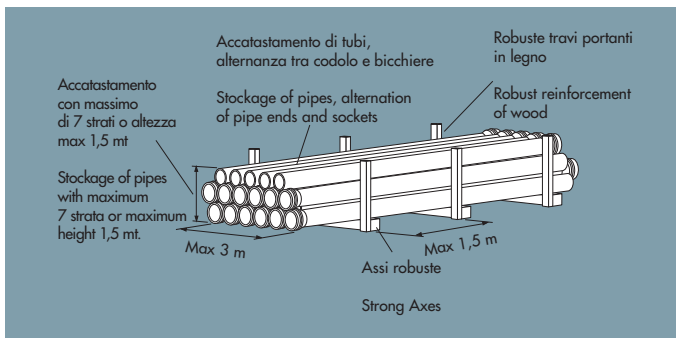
Stoccaggio dei tubi in cantiere - Staking of pipes on the building yard
